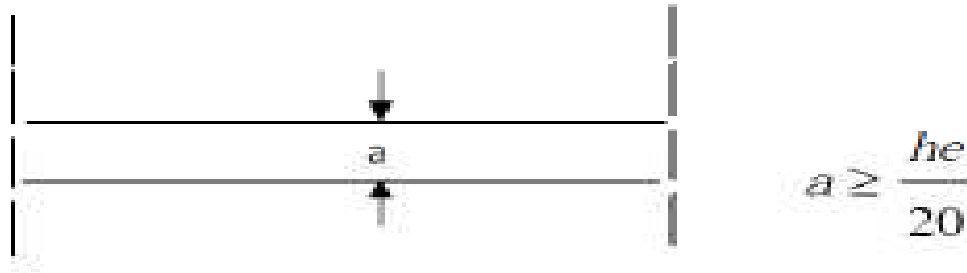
Épaisseurs des voiles - coupe en élévation
